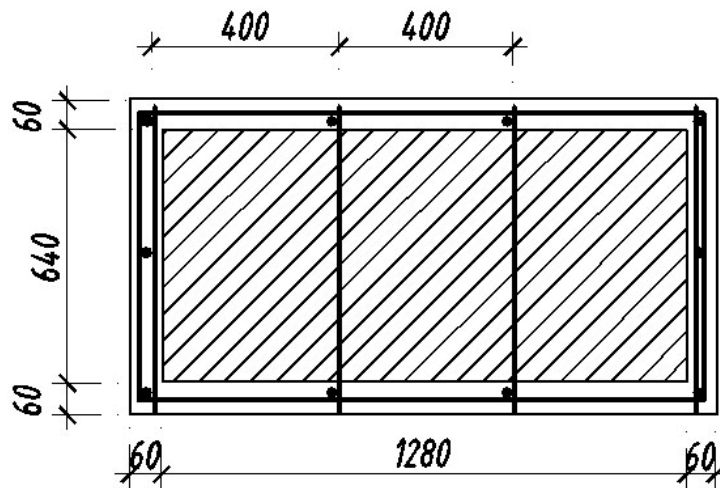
Підсилення кам'яного простінку залізобетонною обоймою
